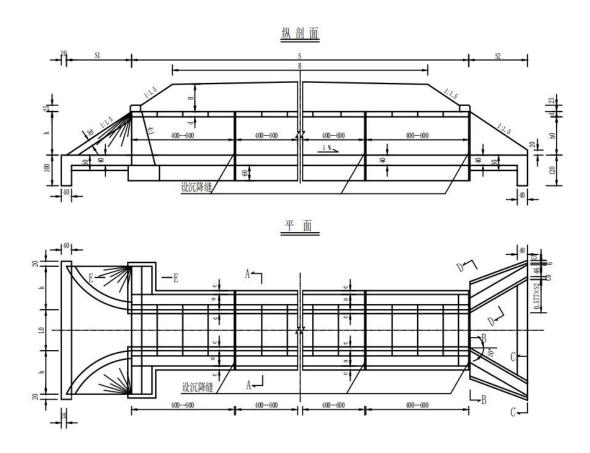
钢筋砼盖板平面、纵坡面图 表 2.4-4 盖板涵工程数量表
